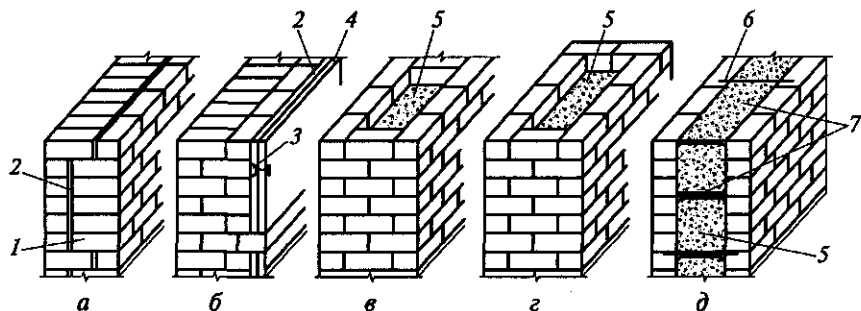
Виды облегченных кладок, применяемых до повышения требований к теплоизоляции стен:
